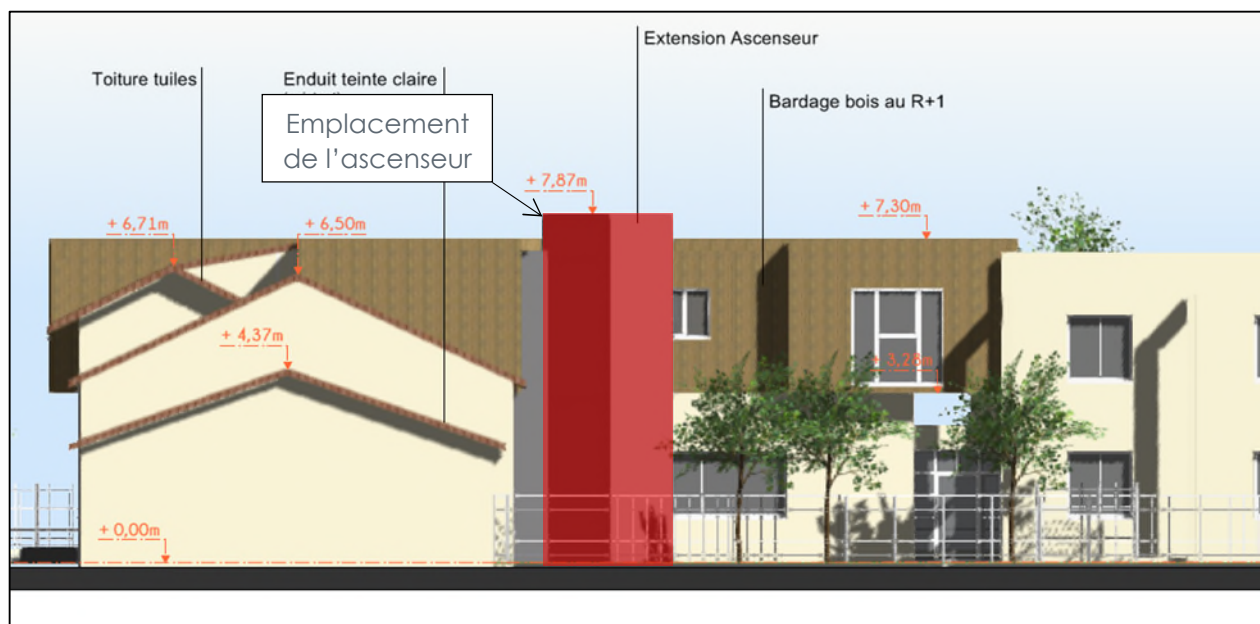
Plan de la façade Sud (source EPSMM, octobre 2023)
